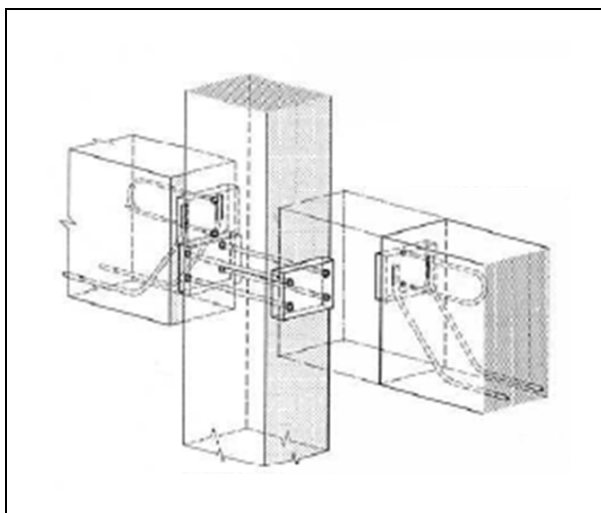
Ligação por consola curta metálica com armaduras em gancho (Stupré, 1981)
